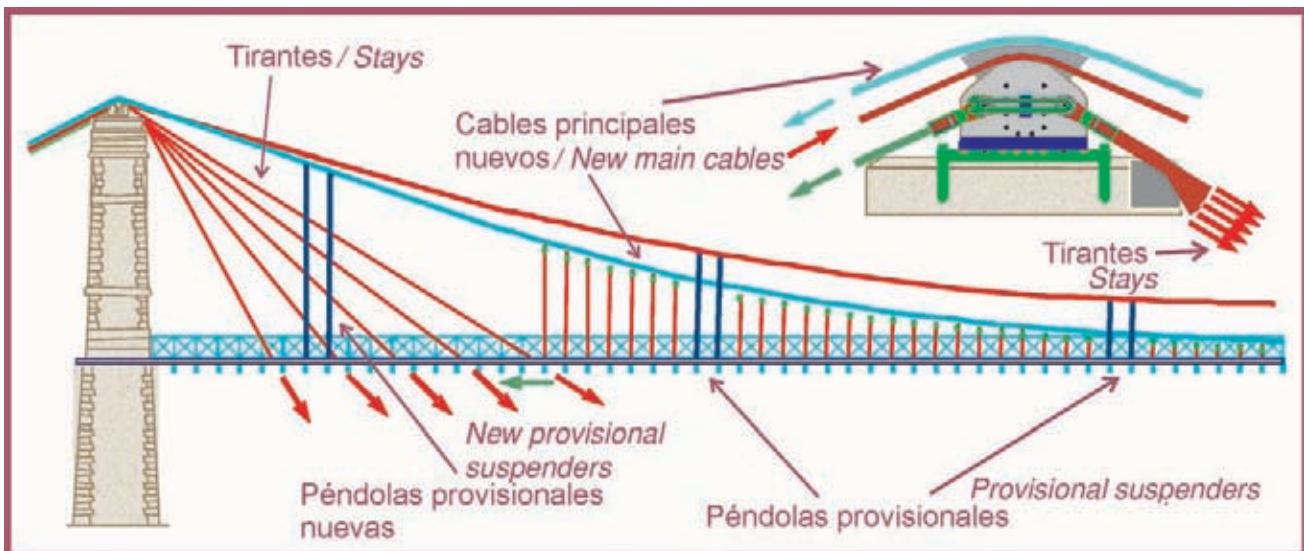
Montaje y tesado de tirantes, cables de retenida y cable horizontal.
